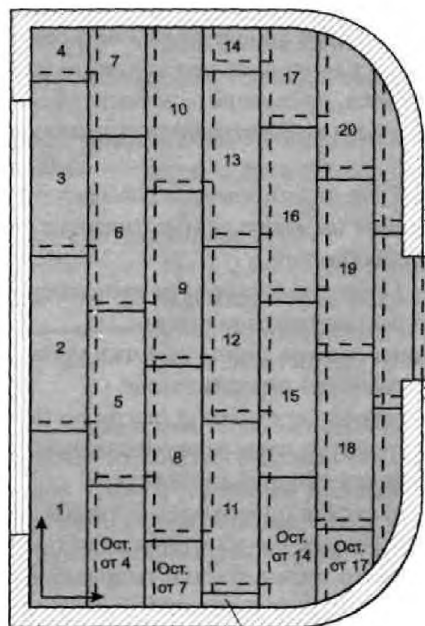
Укладка элементов пола от стены, противоположной стене с дверным проемом.
